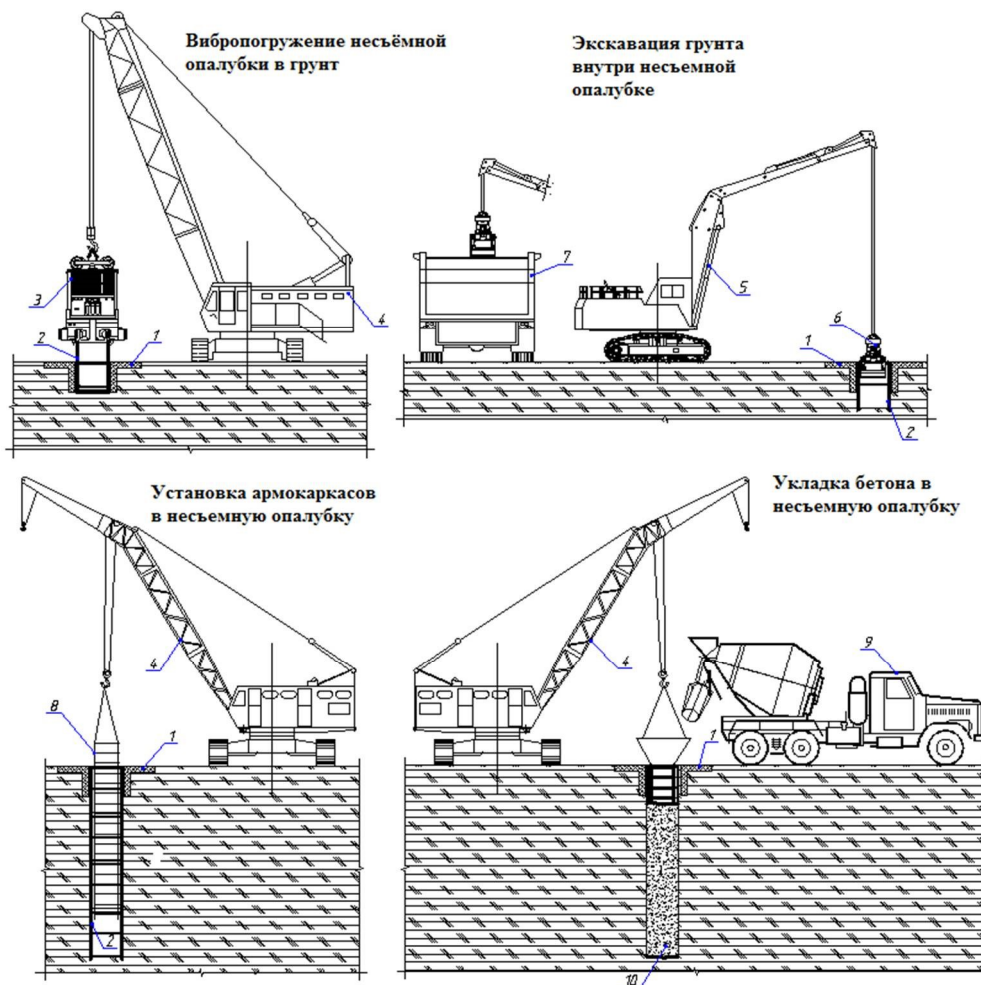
Технологическая схема производства работ при устройстве «стены в грунте» в несъемной опалубке:
